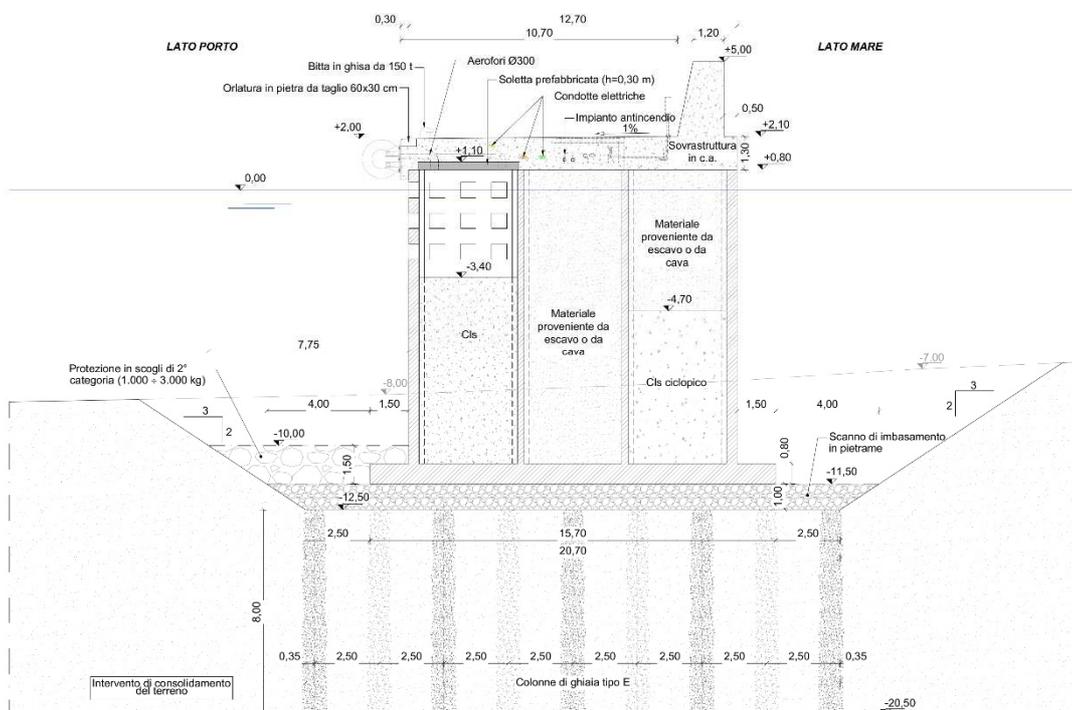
Cassone da n°4 a n°11 (diga a parete verticale): sezione tipo
